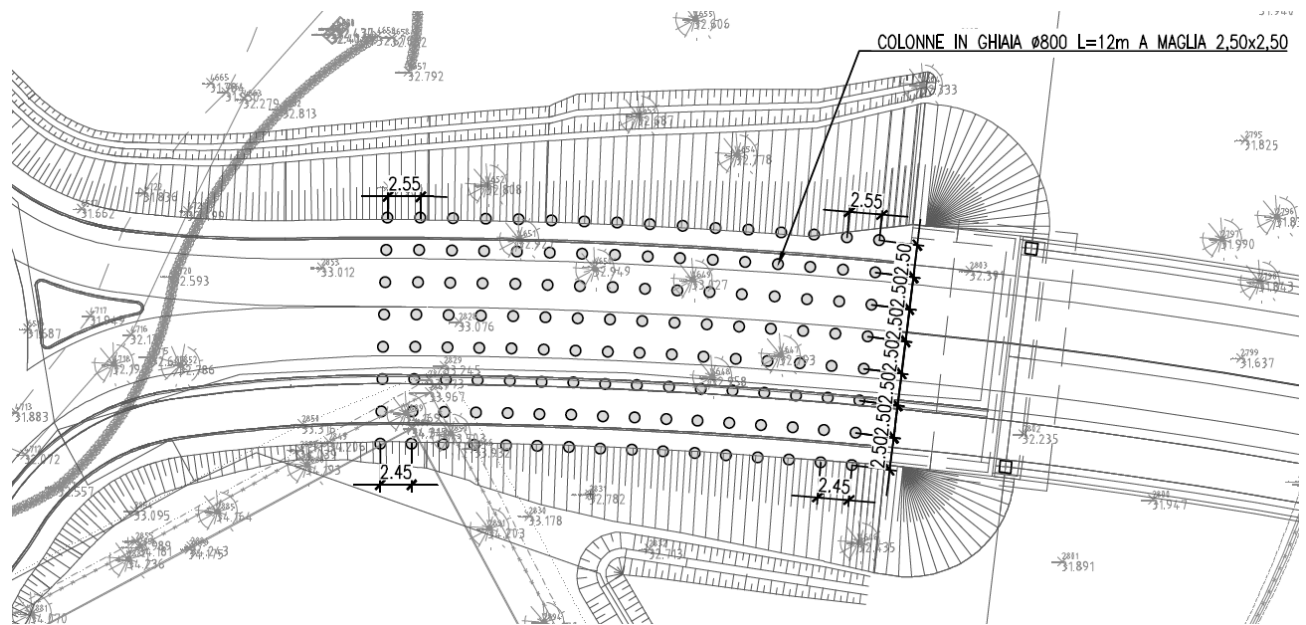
Planimetria intervento colonne in ghiaia per rilevato A01
